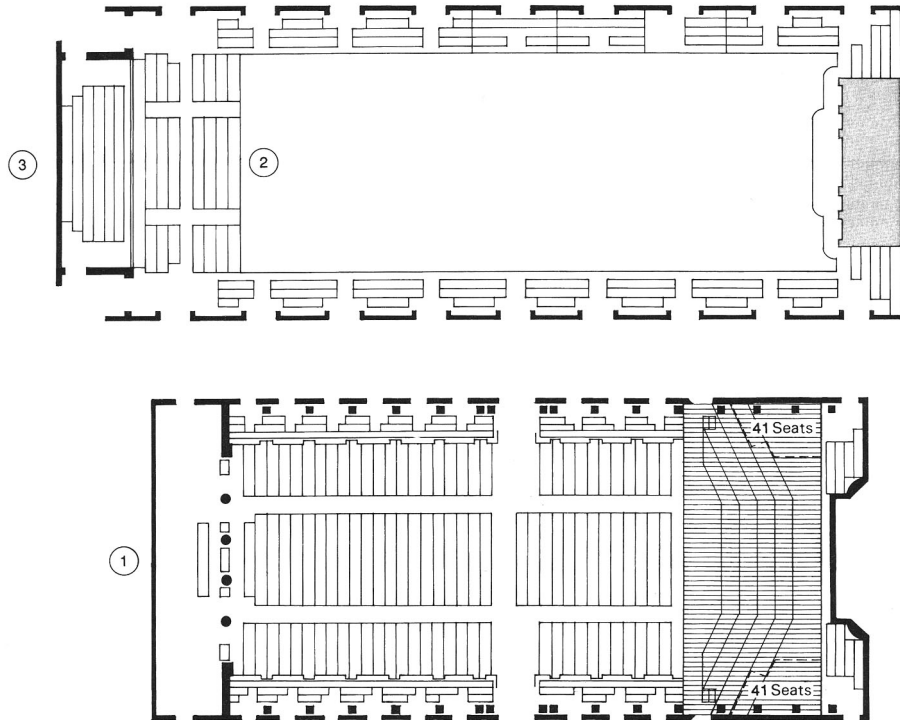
Grundrisse Wiener Musikvereinssaal (Beranek 2004, S. 175)
